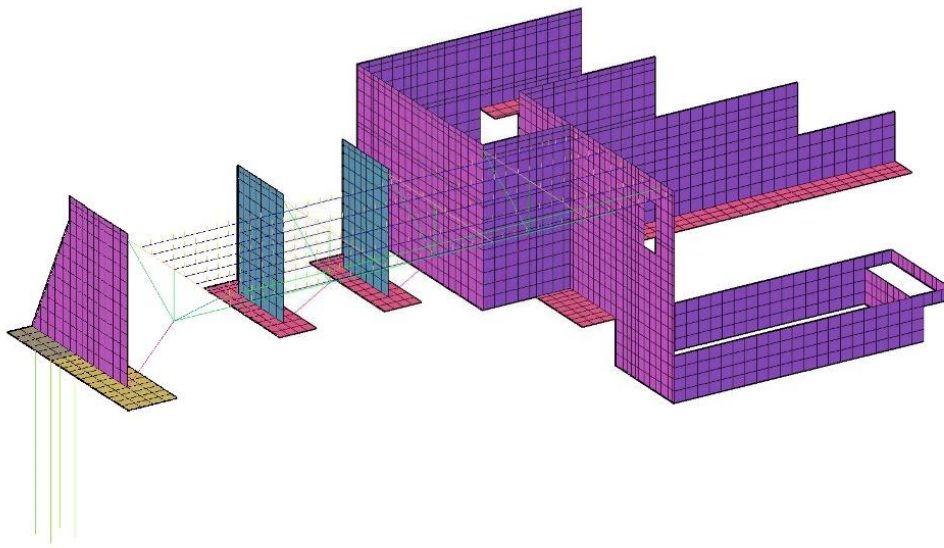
Geometría del modelo en AutoCAD. Cimbra unida a la geometría de la vivienda. Fuente: elaboración propia.
